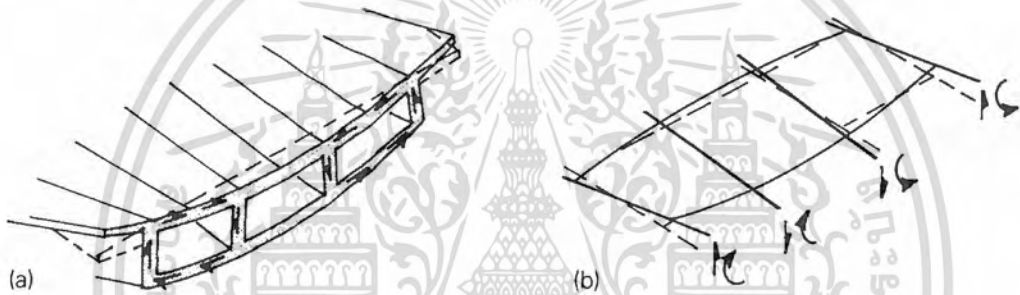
Torsion forces on cross – section of twisted deck and grillage:
